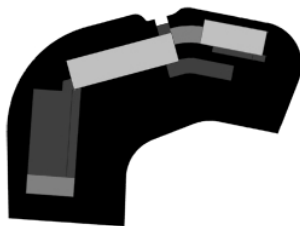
Esquema da planta de implantação da Escola Secundária Emídio Navarro, em Almada.
